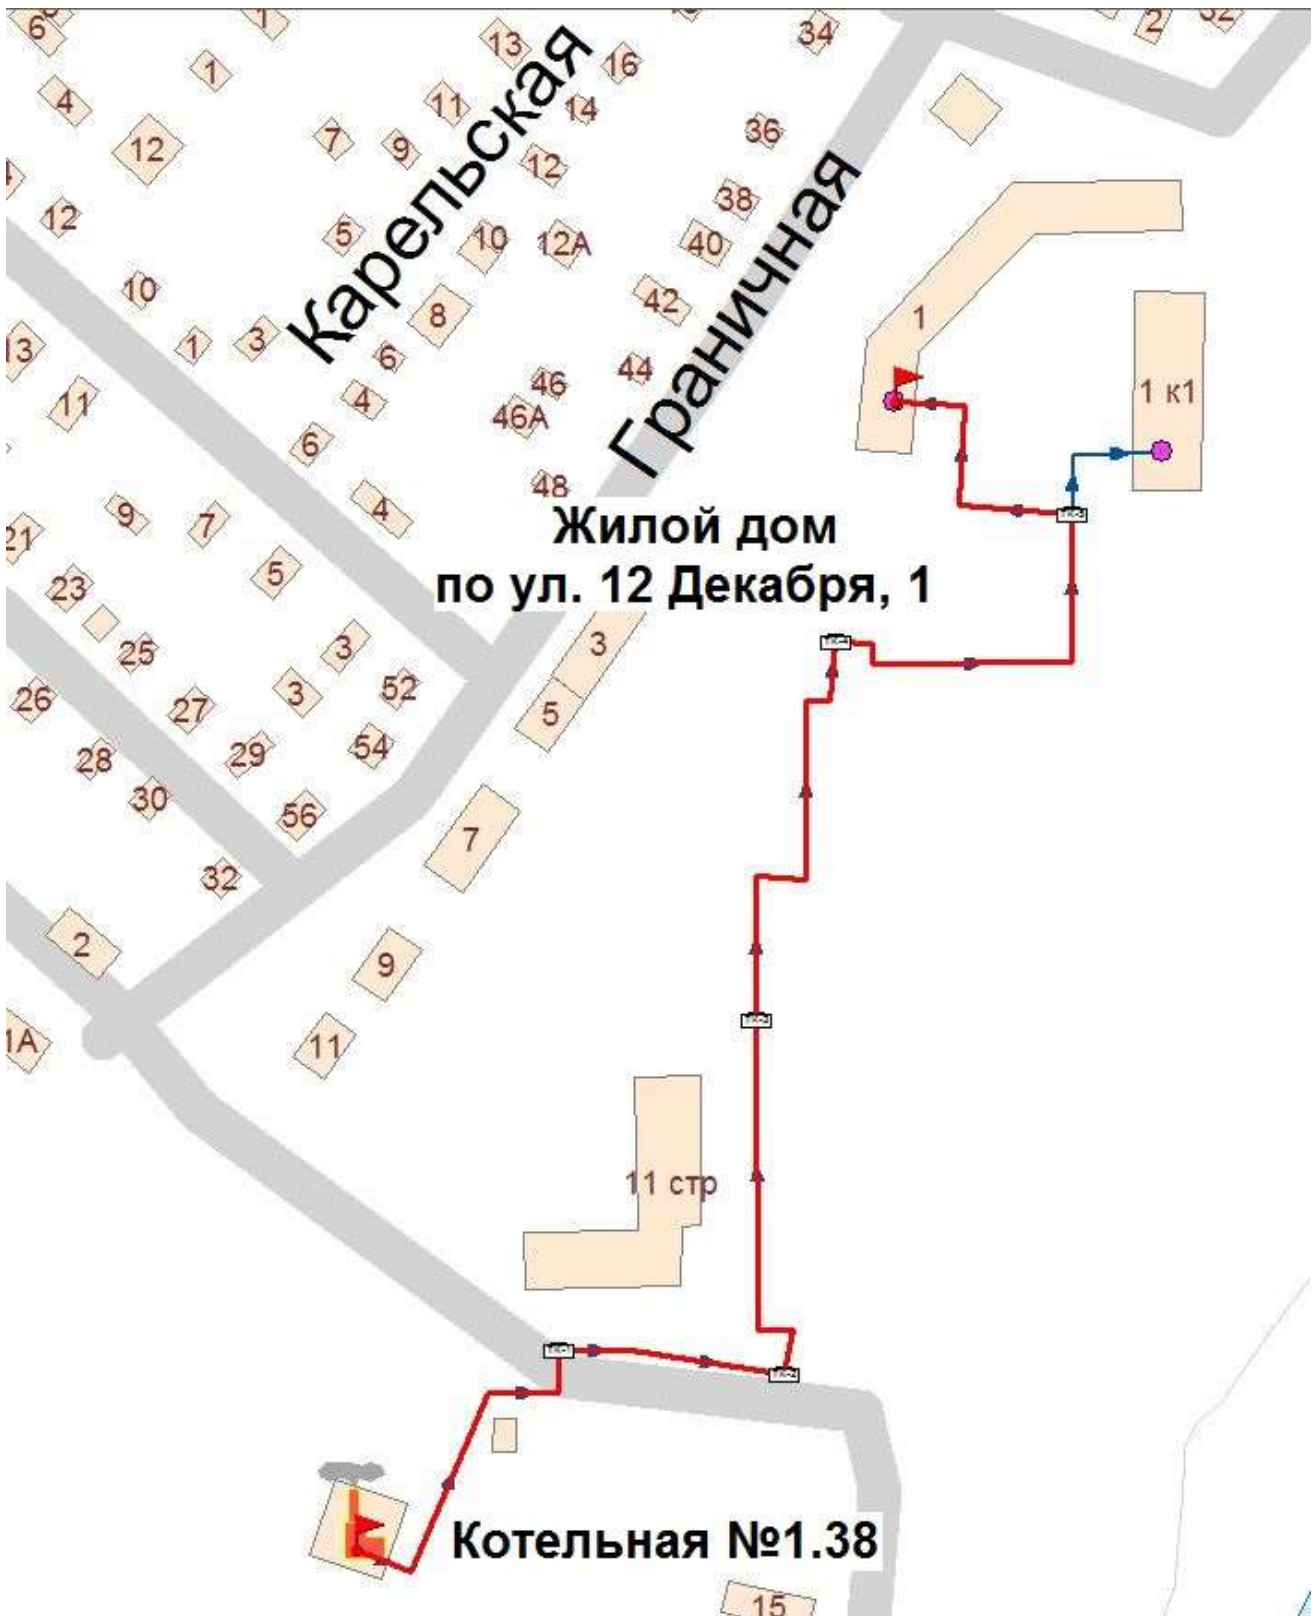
Трассировка теплопровода от Котельной 1.38 до жилого дома по ул. 12 Декабря, 1
